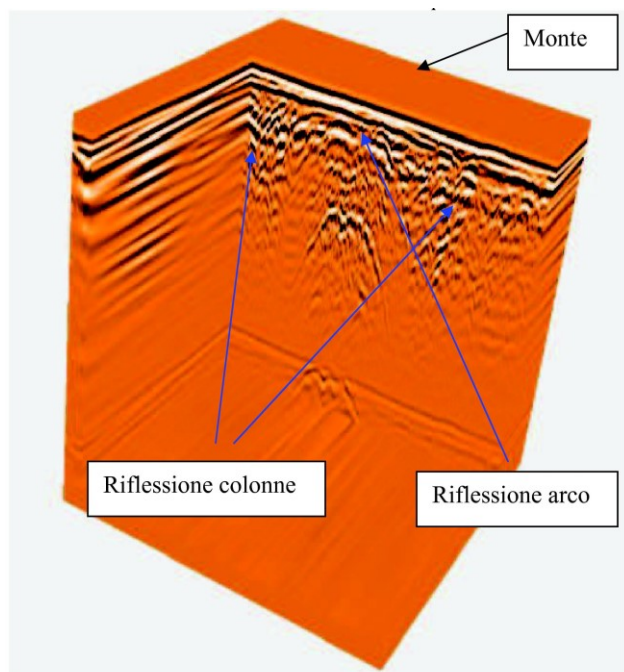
c. Vista 3D profilo 4 sopra il ponte
